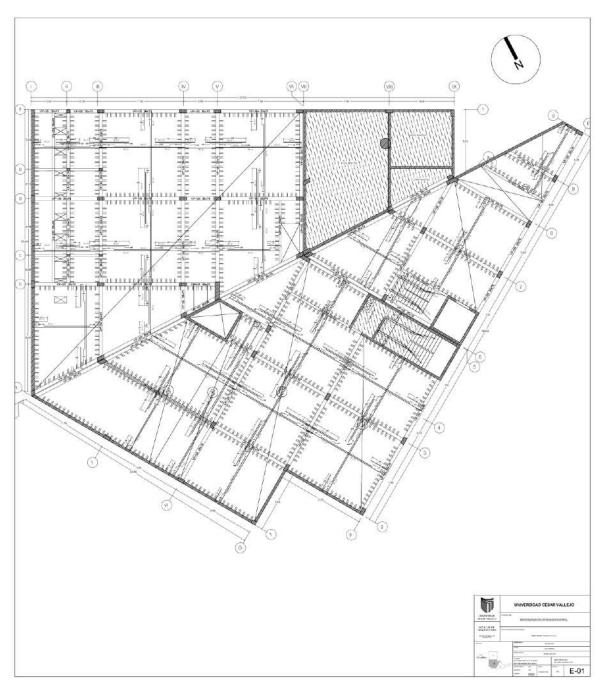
Aligerado - Sótano sector B - ESTRUCTURAS
